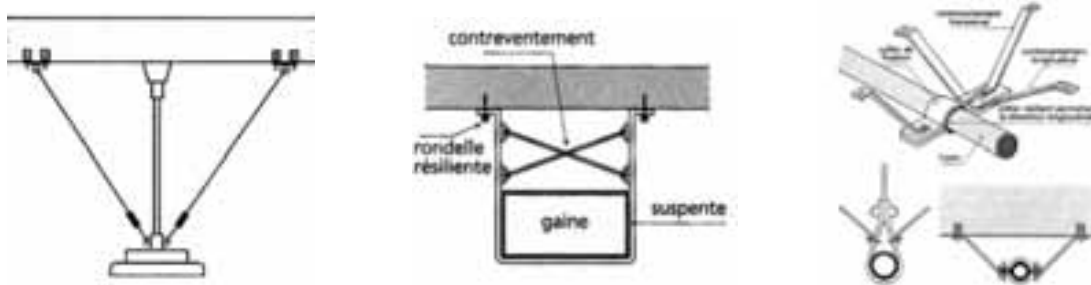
Exemples de contreventement et de fixation d'éléments suspendus (de gauche à droite : luminaire, gaine et canalisations) (Source : Milan ZACEK)
